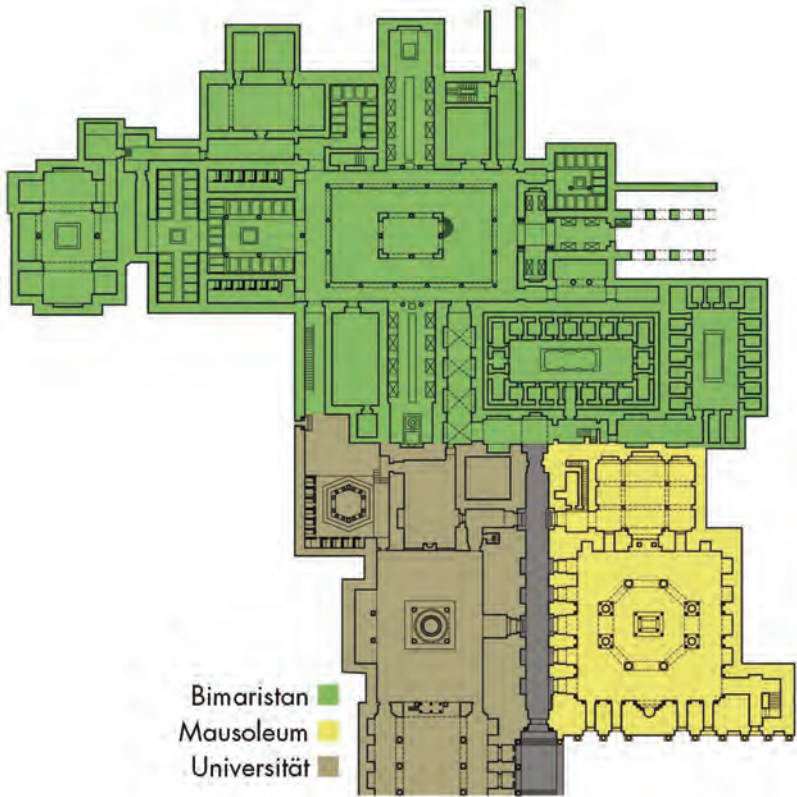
Grundriss des Bimaristans in Kairo
